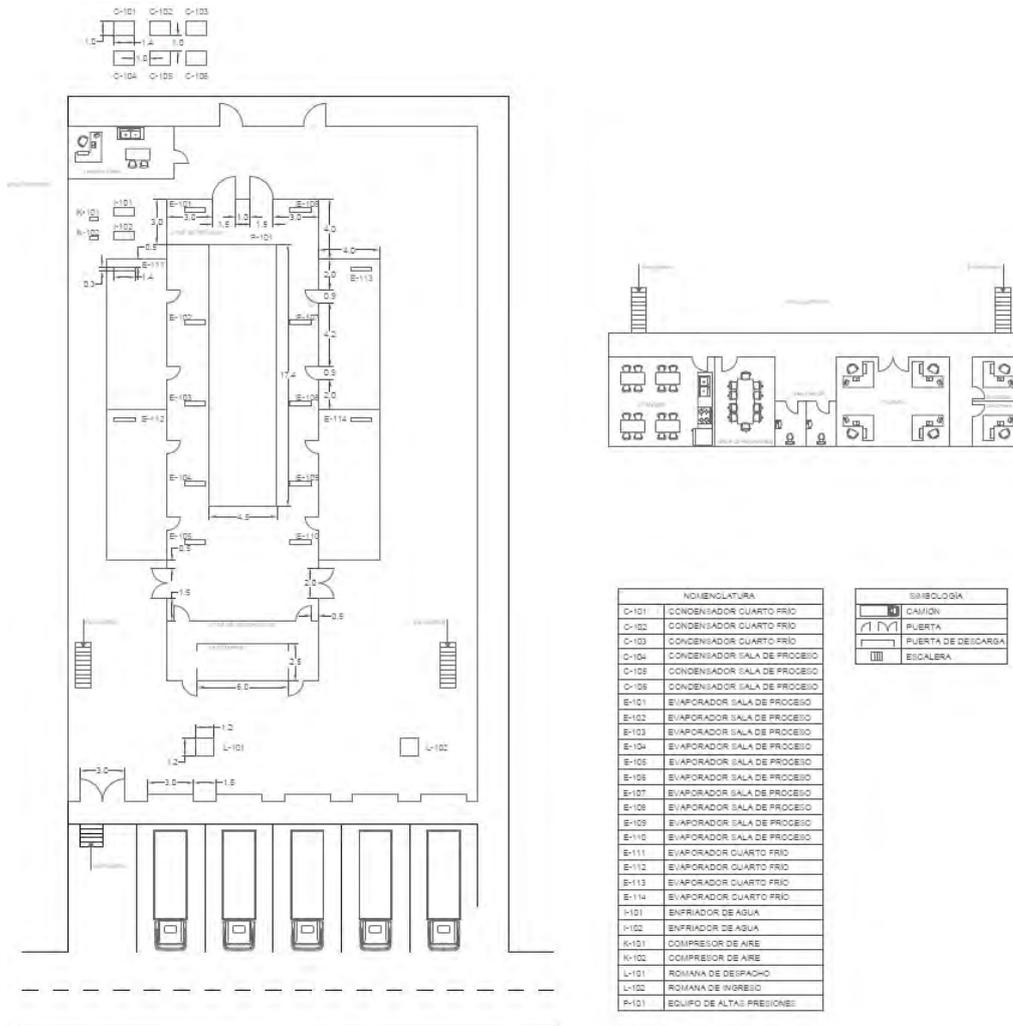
Plano de distribución de planta. Elaboración propia.
